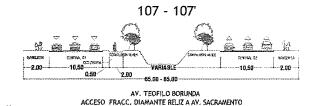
Sección vial propuesta Av. Teófilo Borunda. 73
